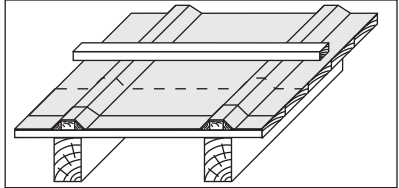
Конструкция крыши с двухслойной вентиляцией
